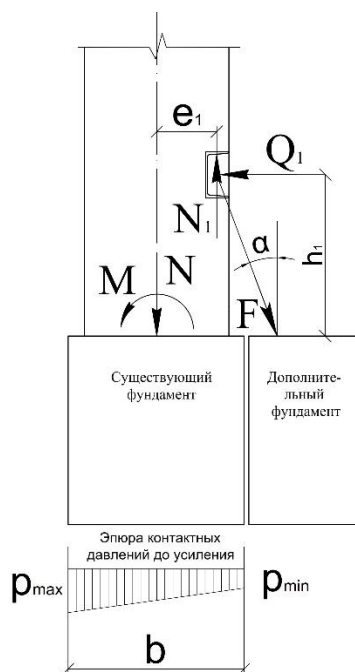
Схема к определению усилий начального нагружения дополнительного фундамента
